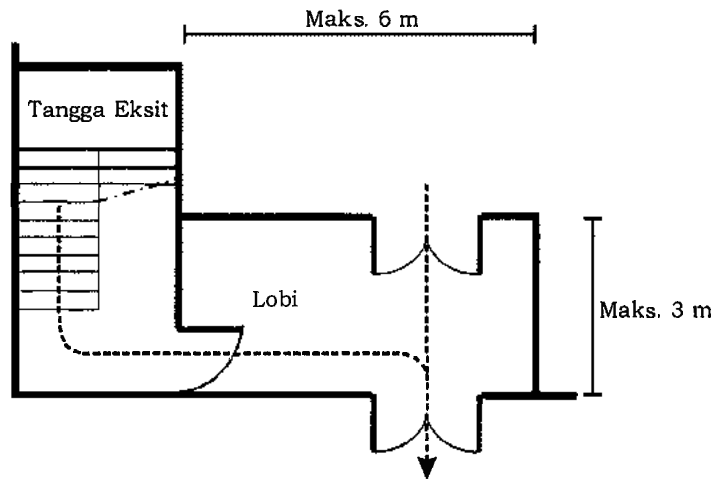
Contoh lokasi eksit pelepasan langsung
